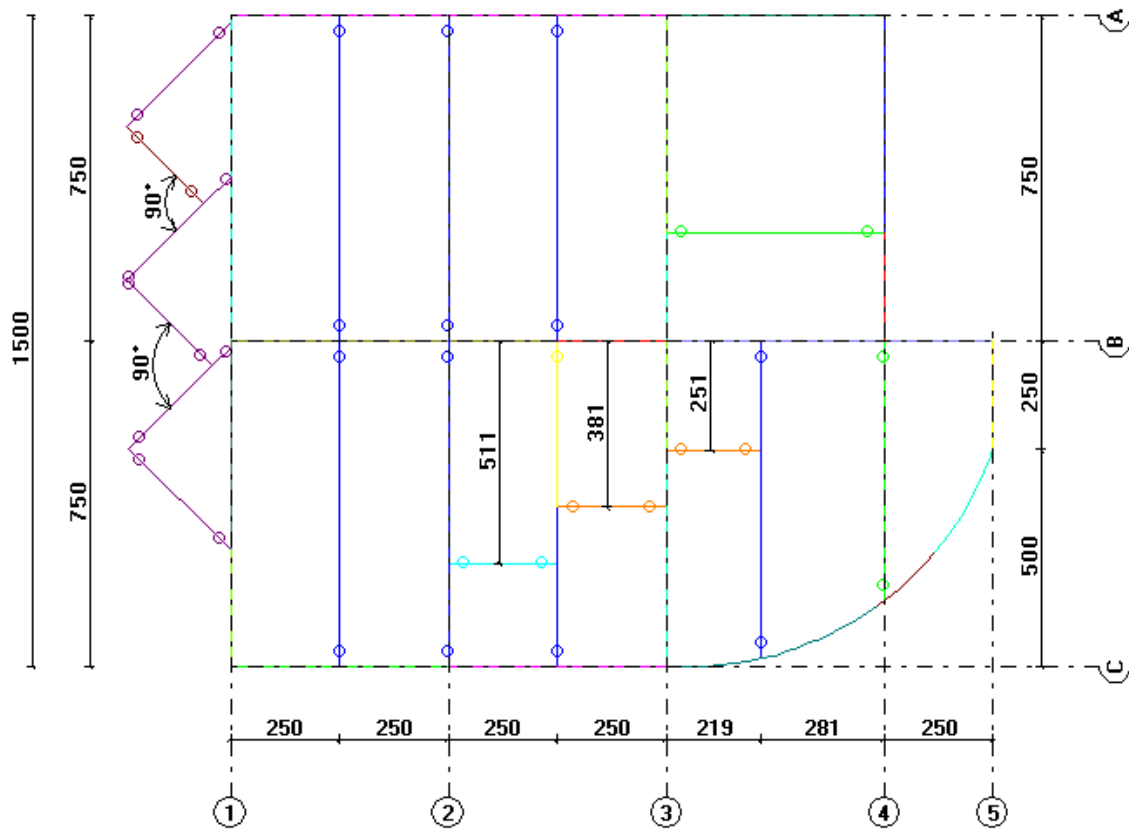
Modelo Estrutural – Planta Cobertura – Dimensões em cm
